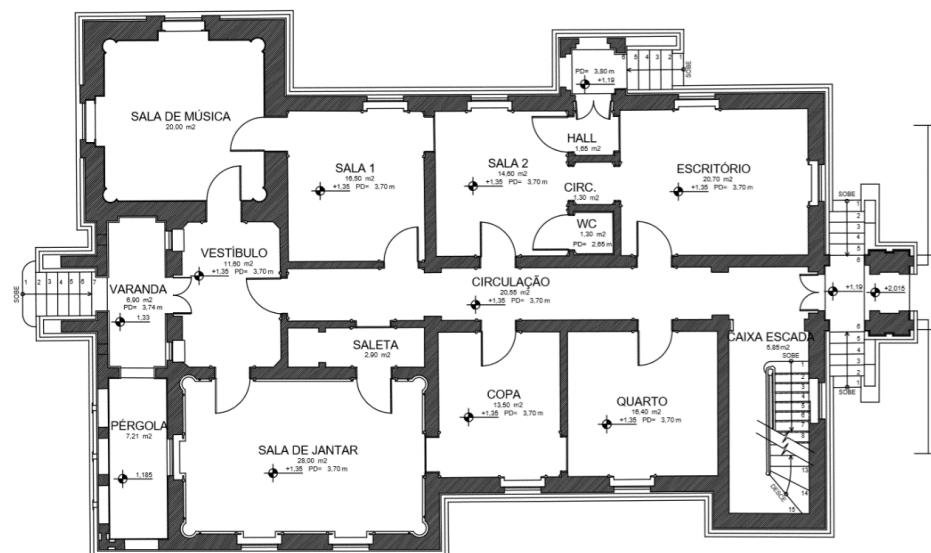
Planta Baixa do Primeiro Pavimento da Villa Ferreira Lage.
